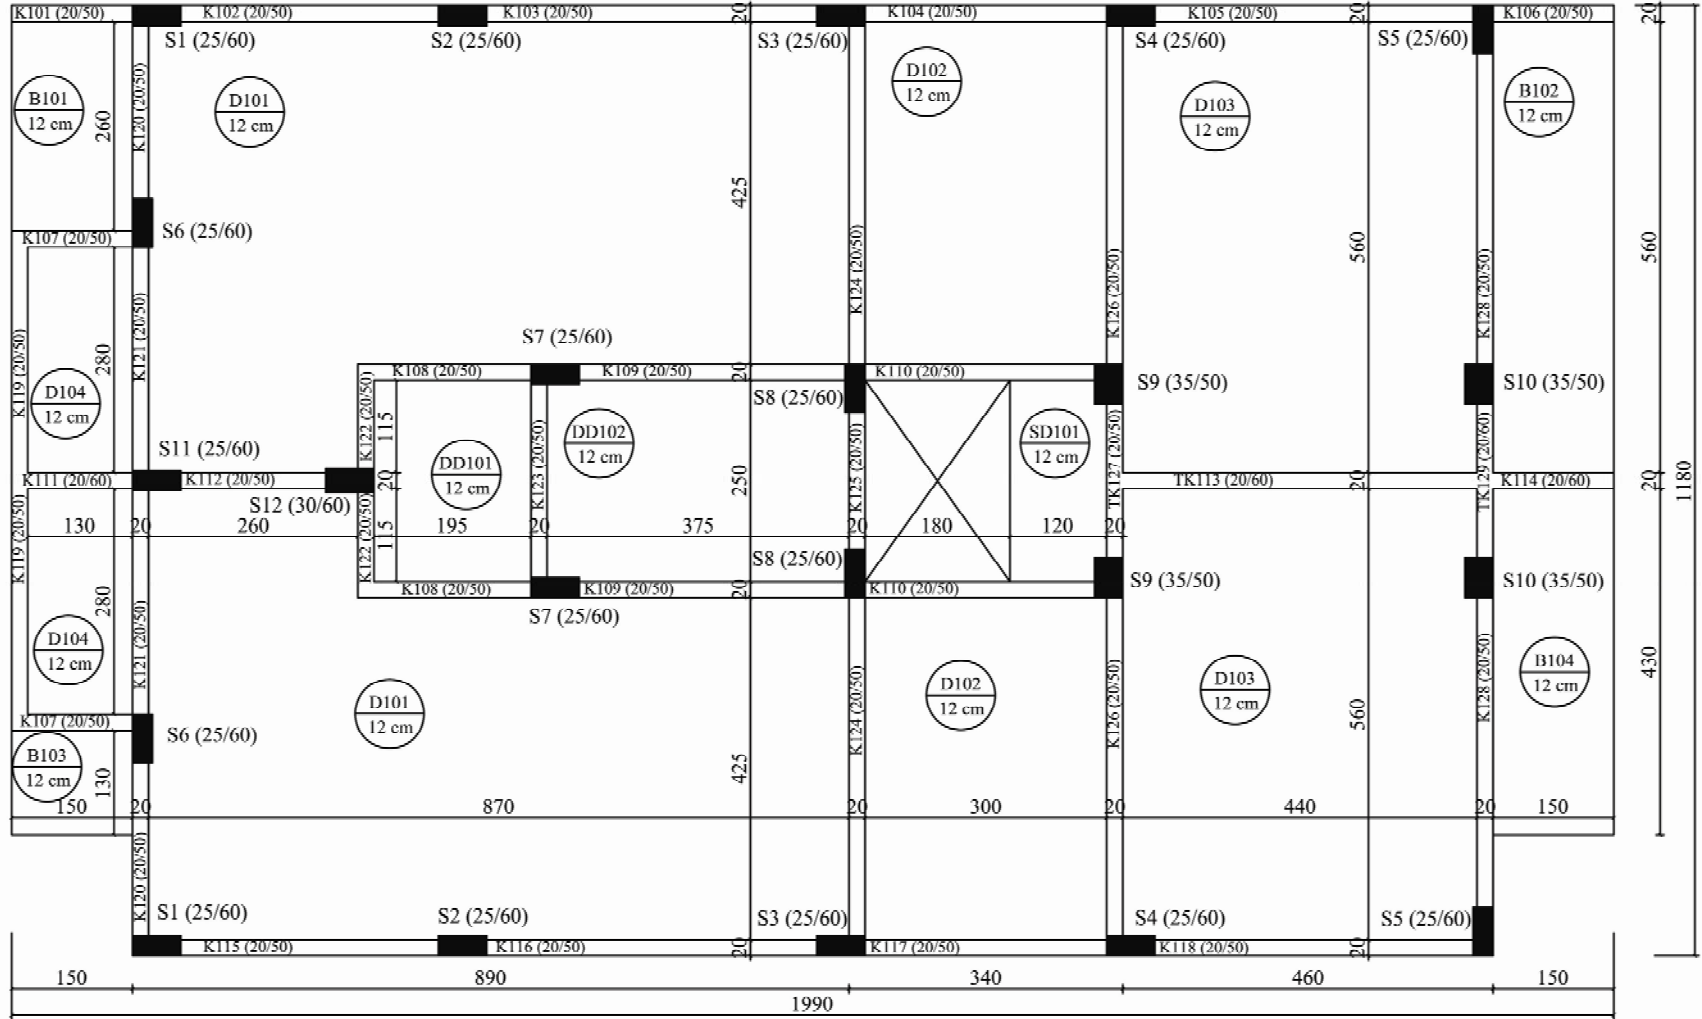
B4\_5'in kat kalıp planı
